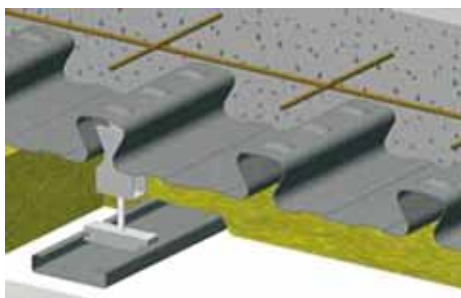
Варианты сталебетонных перекрытий, разработанных в зарубежных странах
